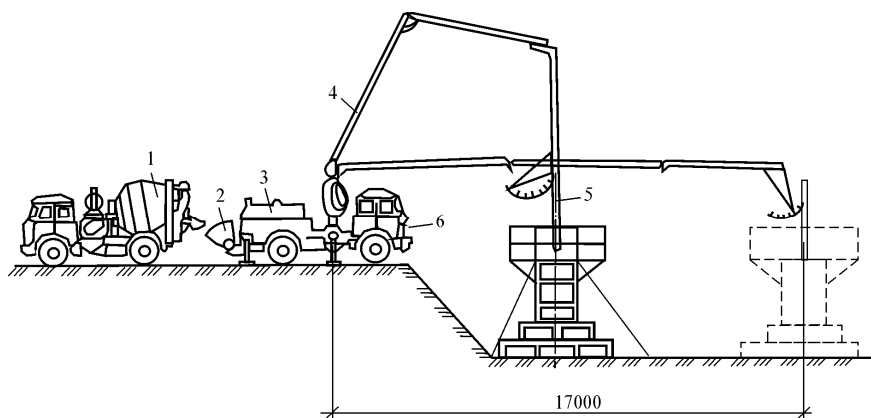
Подача бетонной смеси автобетононасосом при бетонировании столбчатых фундаментов:
